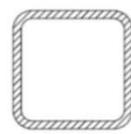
Dimensi dan Bentuk Profil Baja
